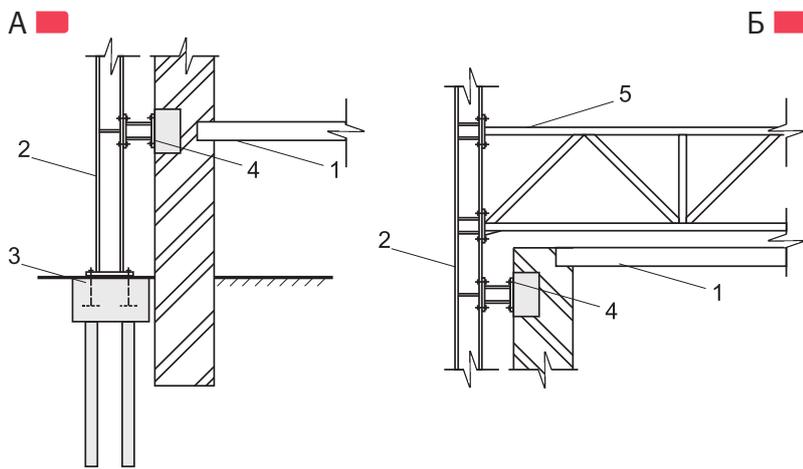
Узлы возведения над существующей формой: А – опорный; Б – обхождение кровли; 1 – существующее перекрытие и стена; 2 – колонна внешнего каркаса; 3 – свайный фундамент; 4 – анкерный узел в стене и кронштейн плавающего шарнира с овальными отверстиями; 5 – ферма нового перекрытия или аутригер с зазором
